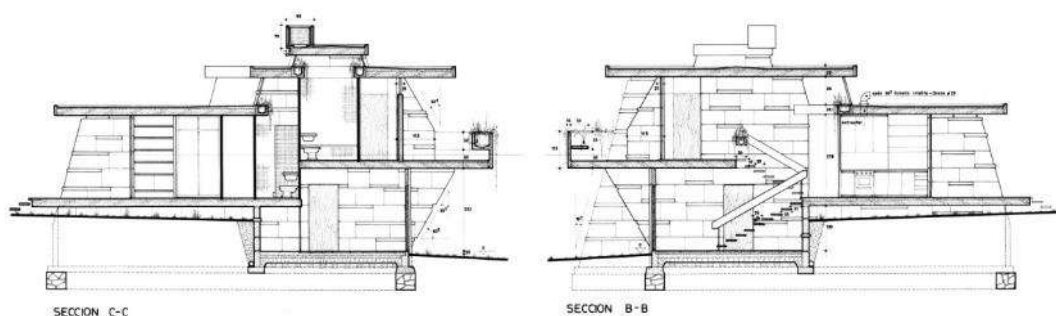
y 19. Casa Vázquez. Secciones C-C y B-B. Plano 2. Redibujado en 1987. (Archivo X.B.B.: Proyecto nº 57).
